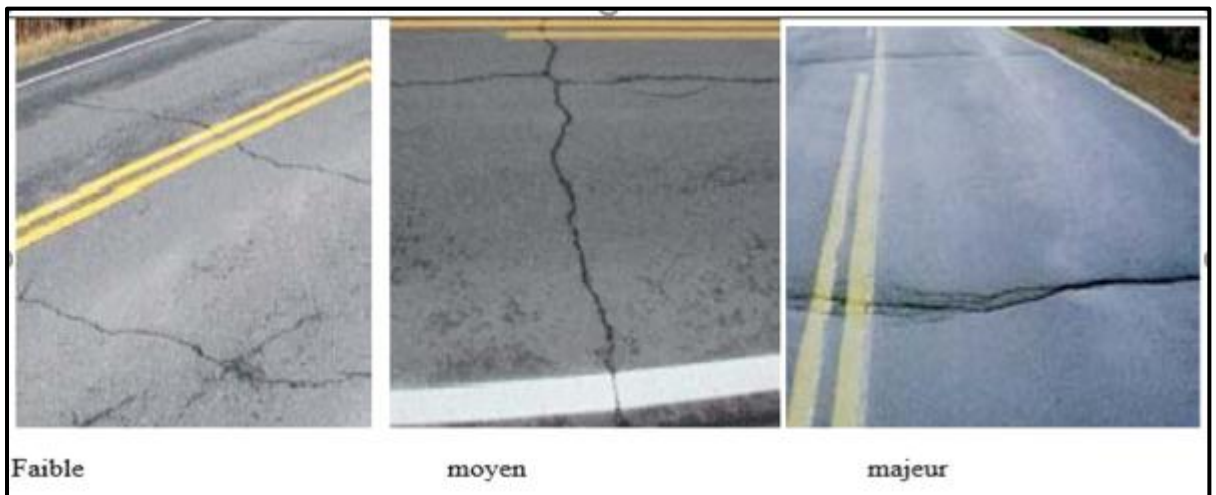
Fissures transversales de la chaussée [4]
